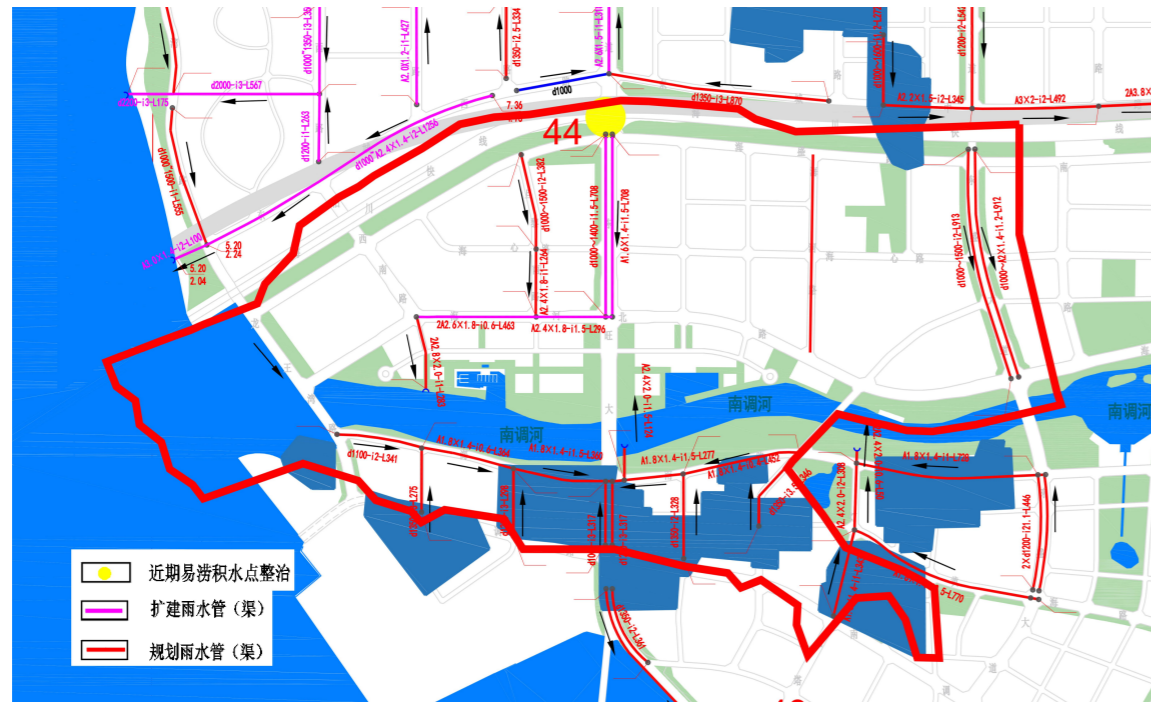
南调河下游分区近期新、改扩建雨水管渠平面图
